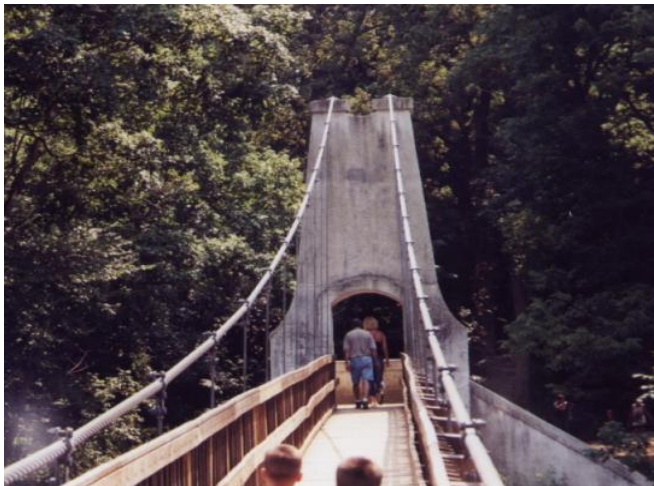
Detalle del diseño estructural y arquitectónico de los pórticos de concreto
